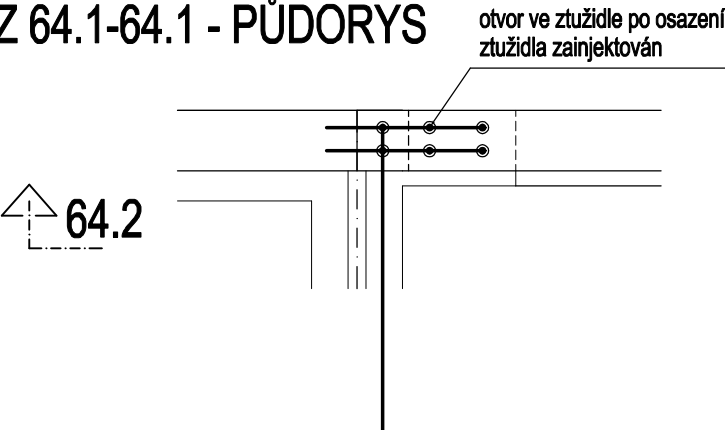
ULOŽENÍ STĚNOVÉHO ZTUŽIDLA (PŘEKLADU)
